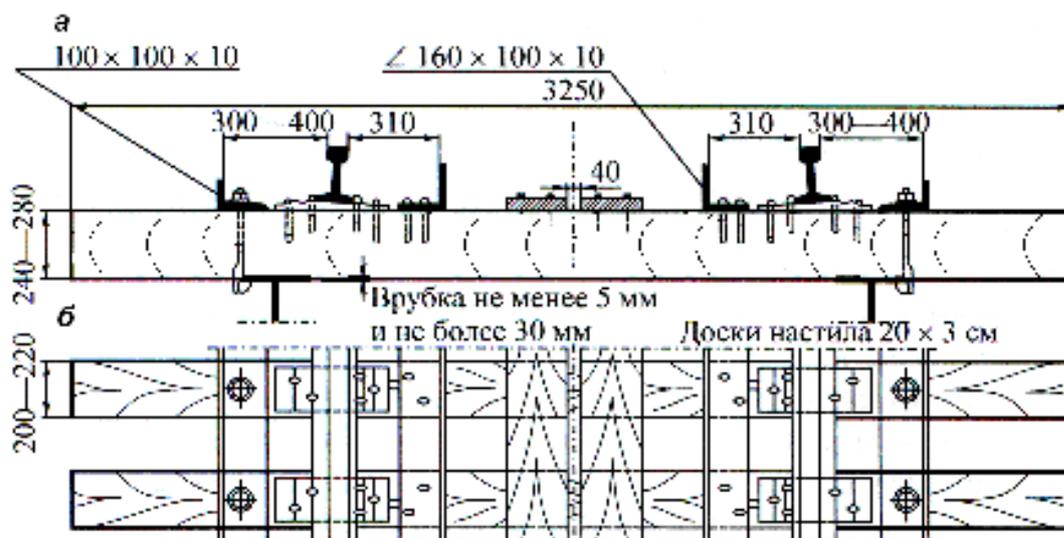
Конструкция мостового полотна с ездой по деревянным поперечинам: а – поперек оси моста; б – план
